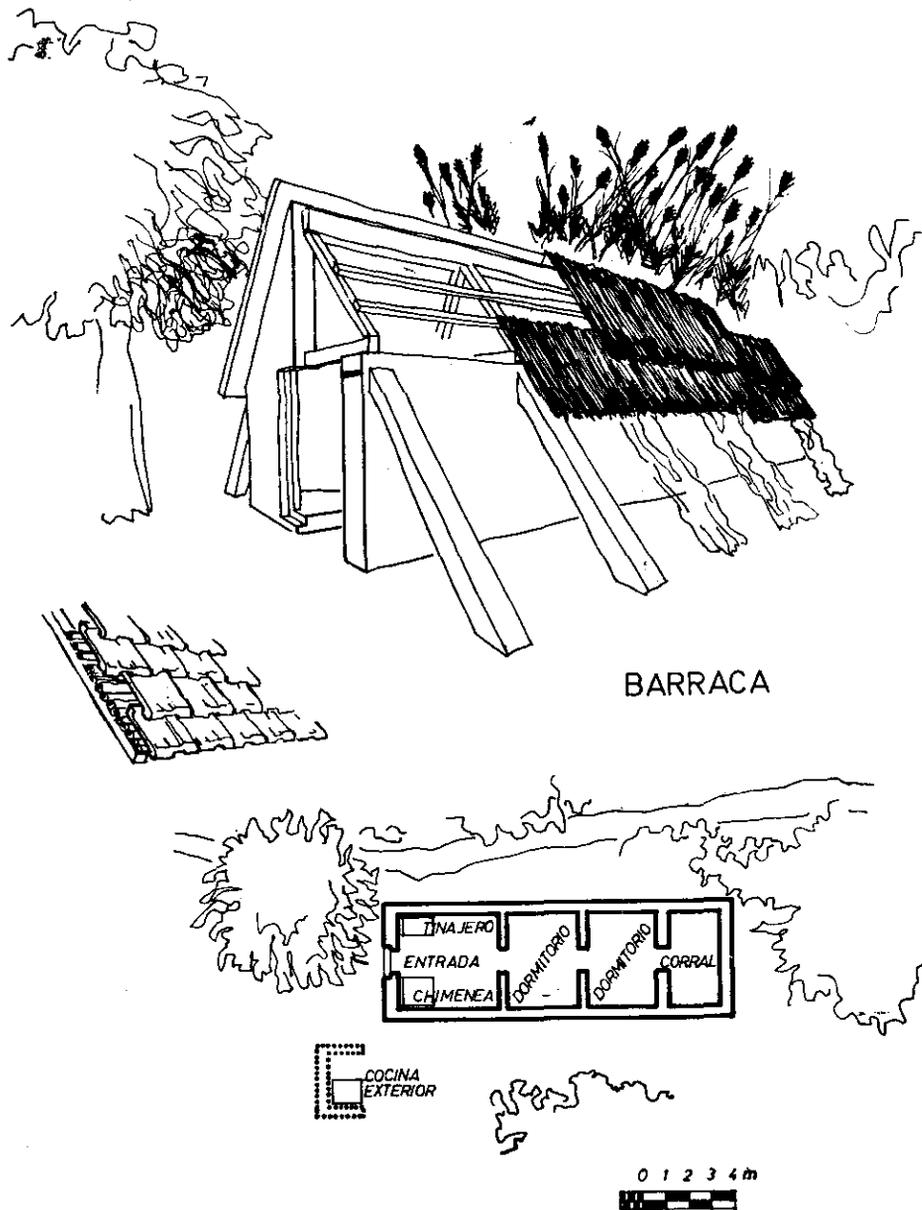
Estructura de una barraca en perspectiva ideal. Detalle de tejado moderno y planta a escala inferior.
